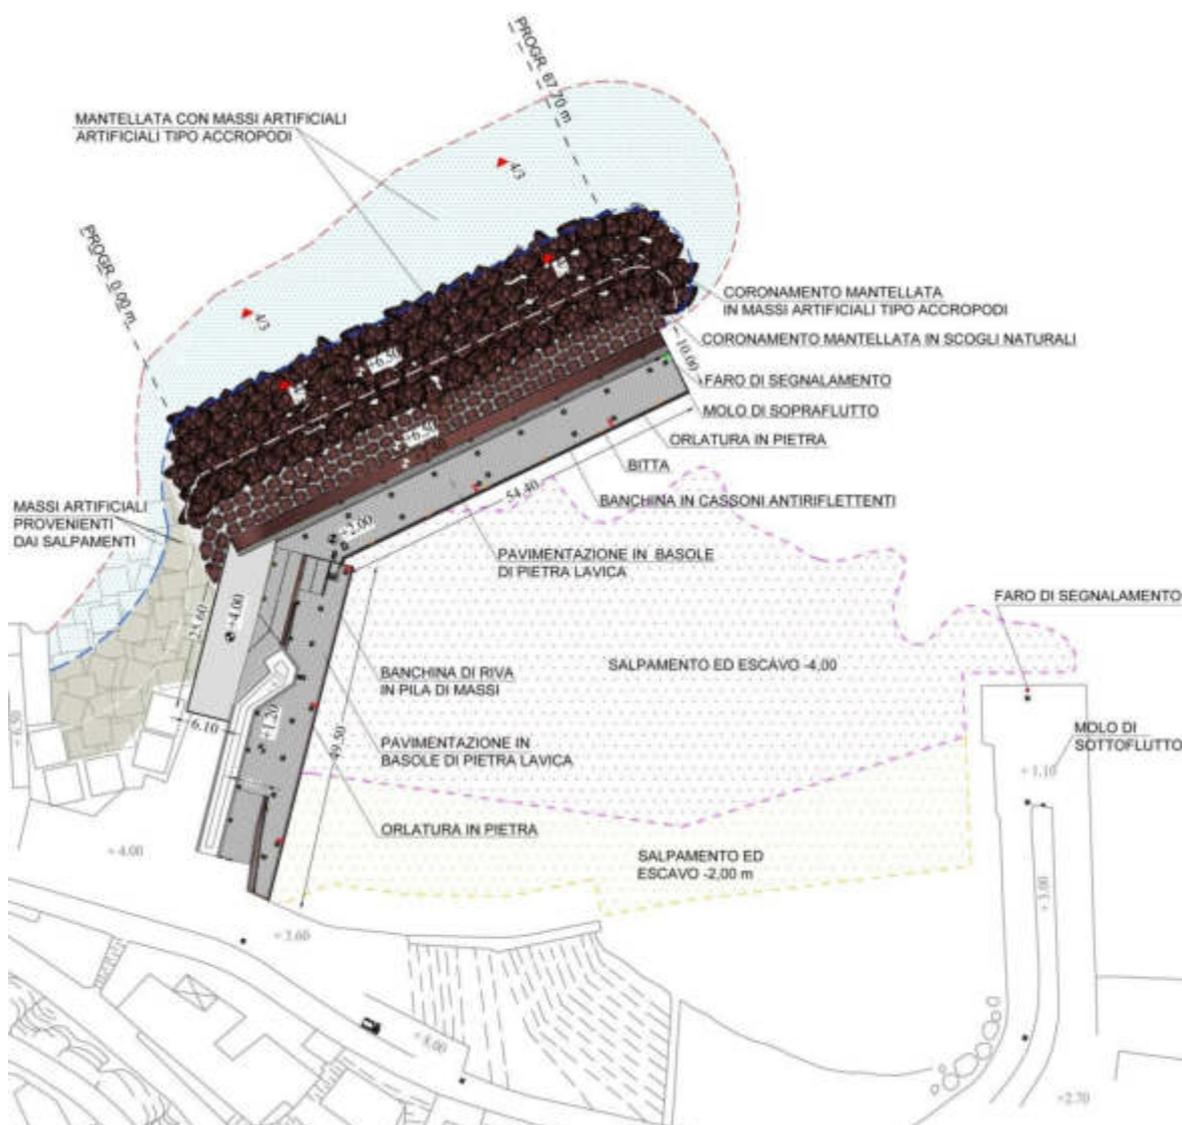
Planimetria - Progetto 1° Stralcio funzionale del 2006
